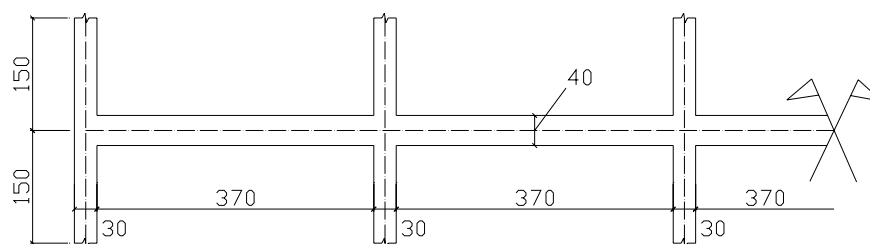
Geometria da viga, Caso 4 (dimensões em cm)
